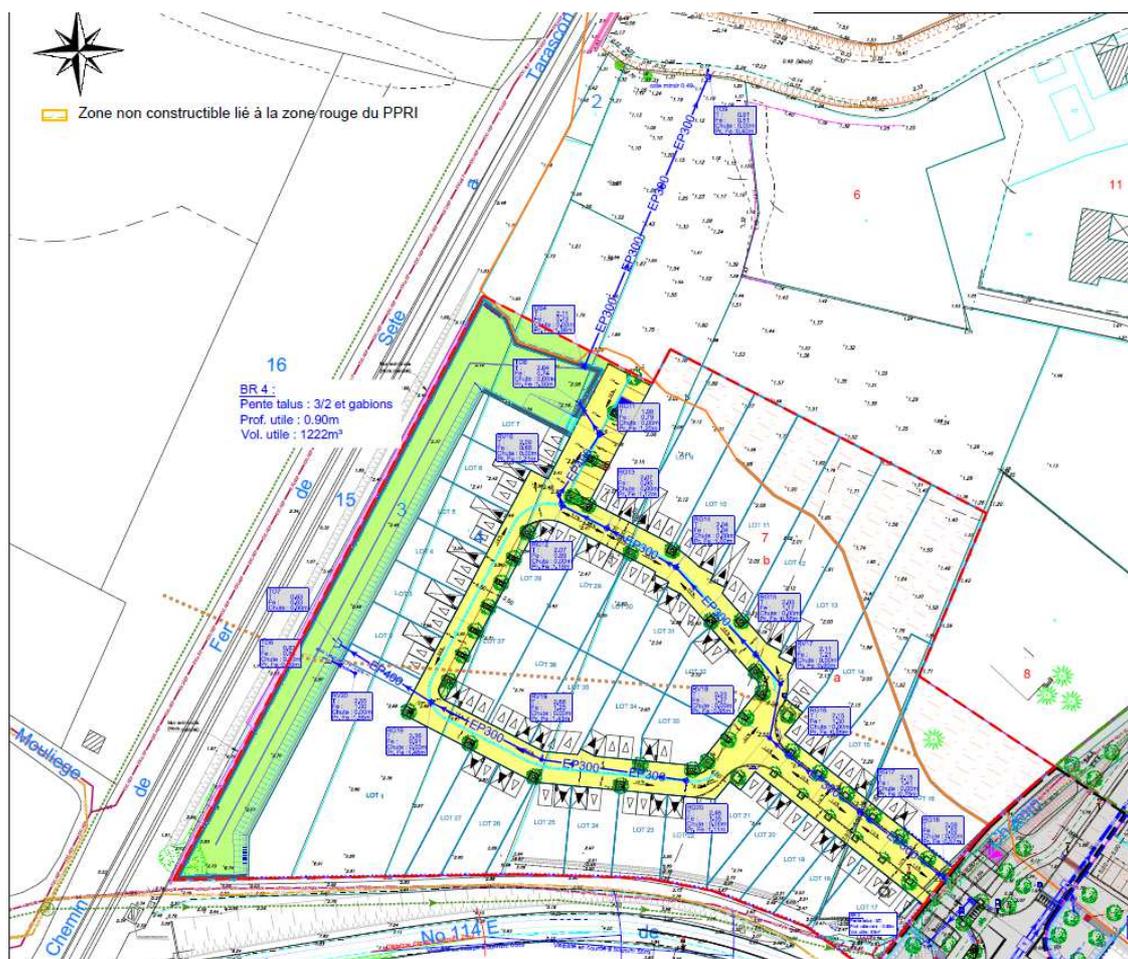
Extrait du Plan de principe de gestion des eaux pluviales _ Dossier Loi Eau l'Esplanade Ouest _ SERI_ Mars
